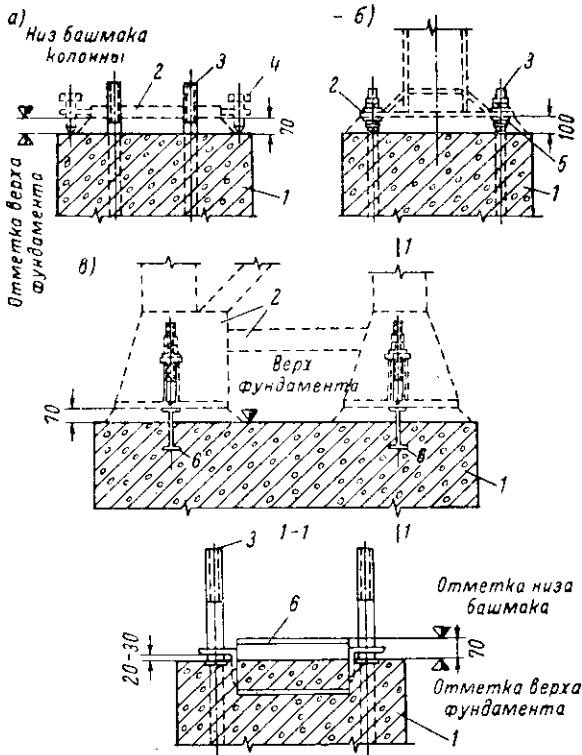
Опираение стальных конструкций колонн на железобетонные фундаменты
